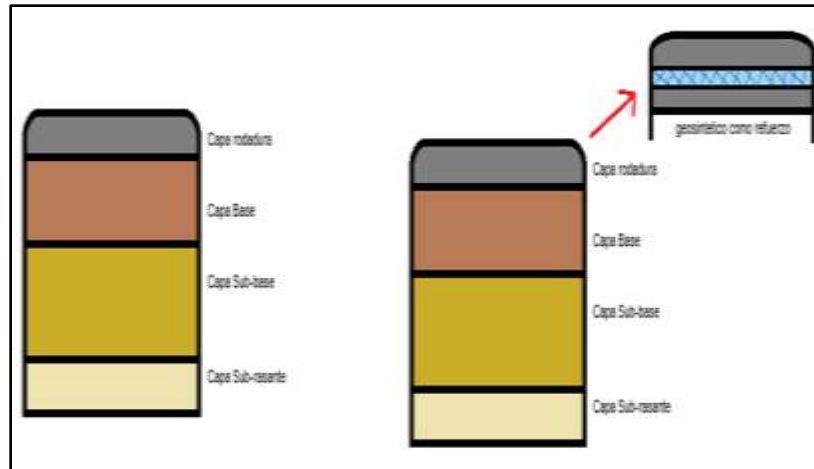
Sección Transversal con y sin refuerzo de geo sintético Fuente. Este Estudio
